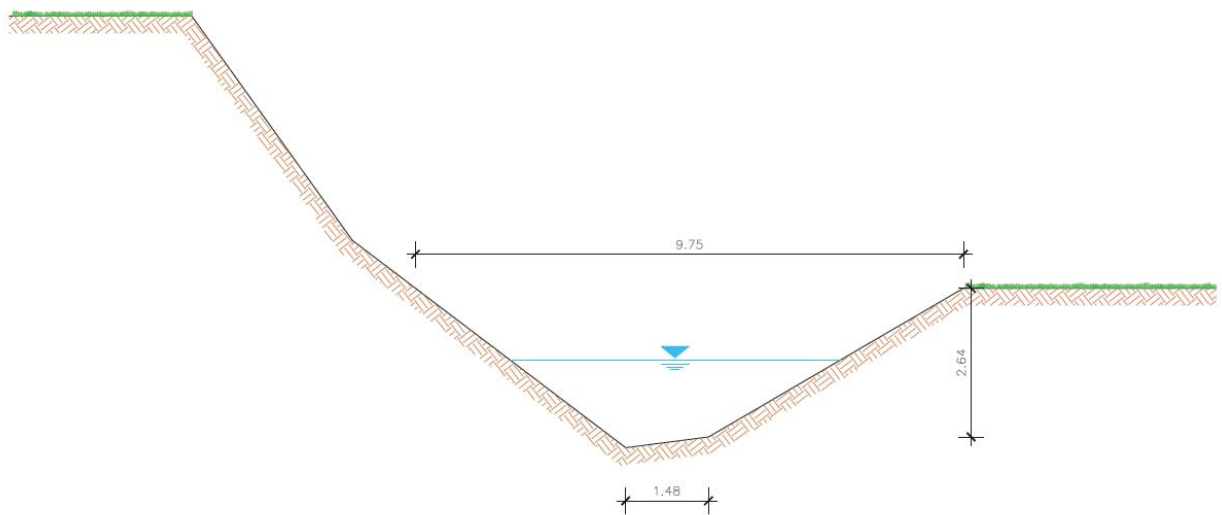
Sezione del canale Lecche, lato ovest dell'attraversamento stradale
